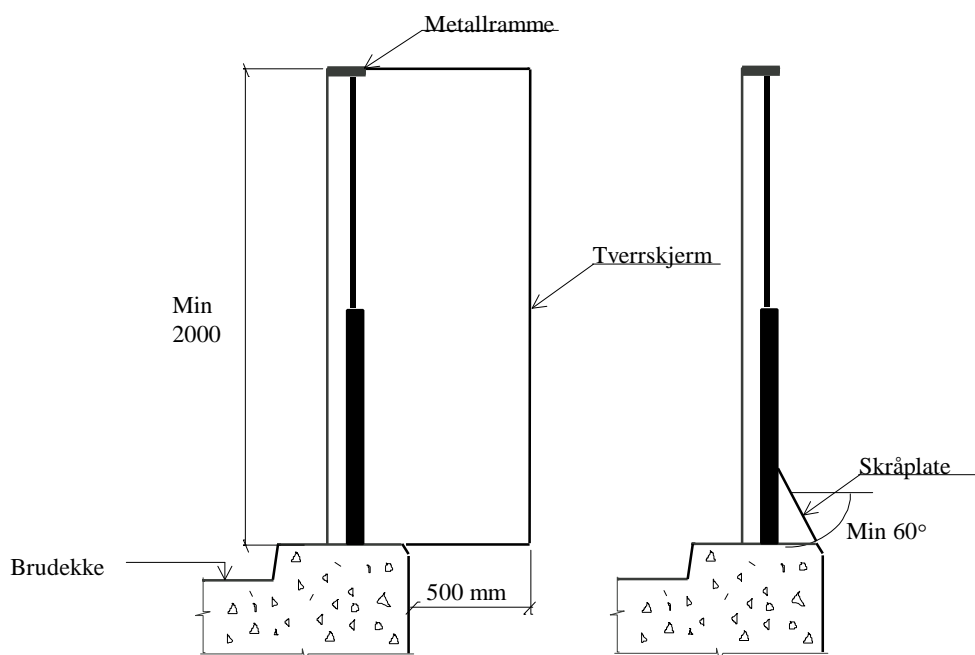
Krav til utstrekning av beskyttelsesskjerm. Plan
